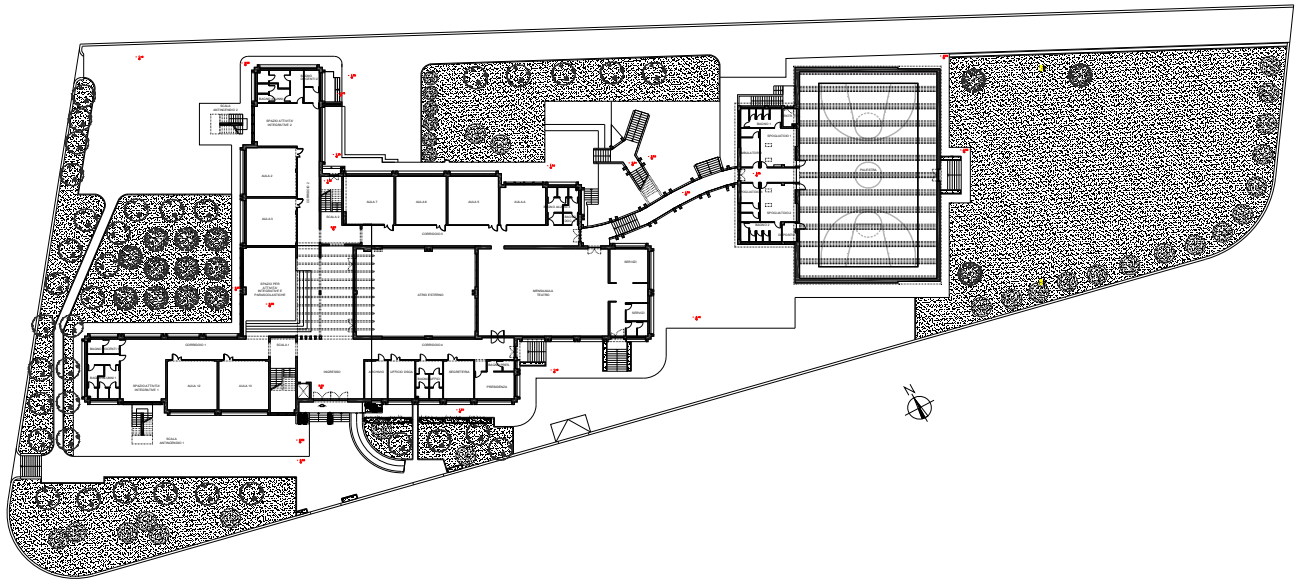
Pianta Piano Rialzato dell'Intero Plesso Scolastico
